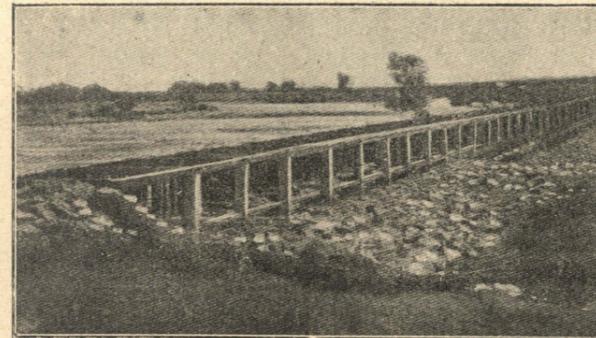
Diga in cemento armato lungo il fiume Missouri.
